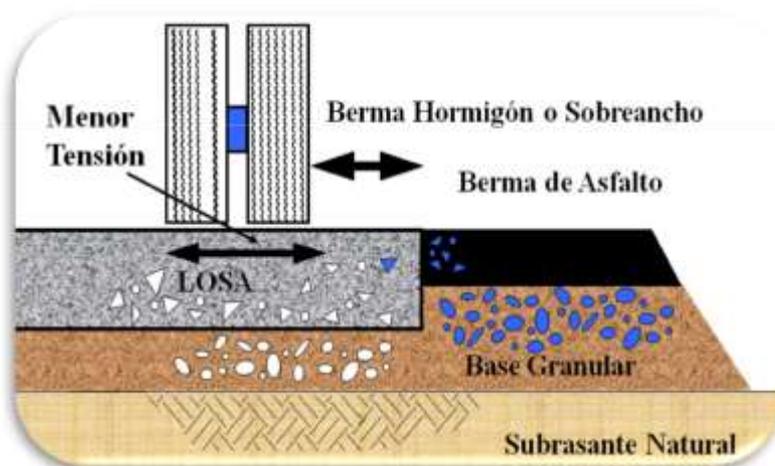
Tensiones Menores con Sobre Ancho de Hormigón.
